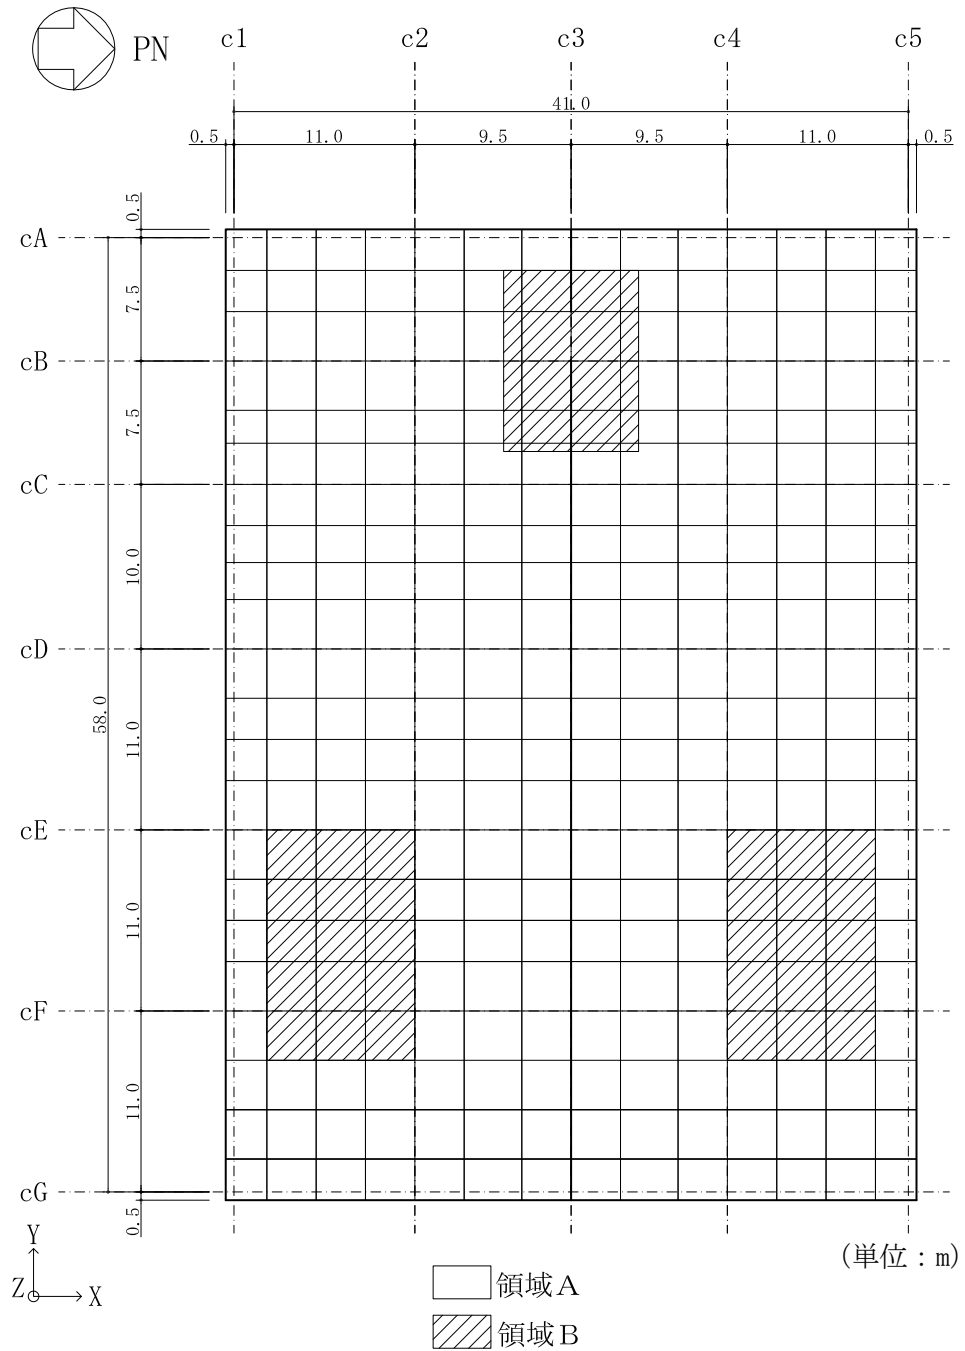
基礎スラブの配筋領域図 (EW 方向, 上ば筋)
